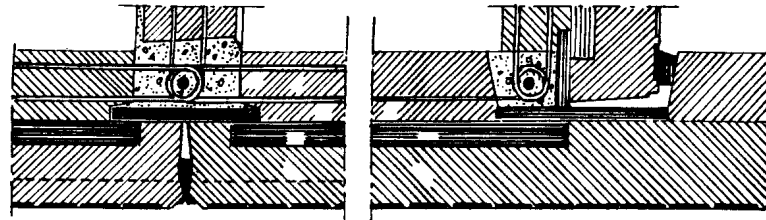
Juntas verticales de paneles de fachada, de traviesa y de esquina. Sección horizontal.
